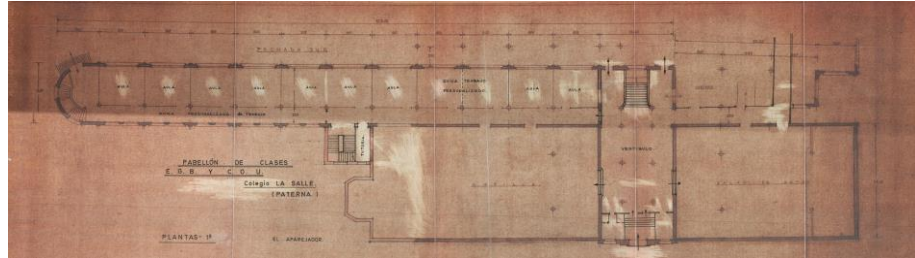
Primera planta del pabellón de las clases del Colegio La Salle
